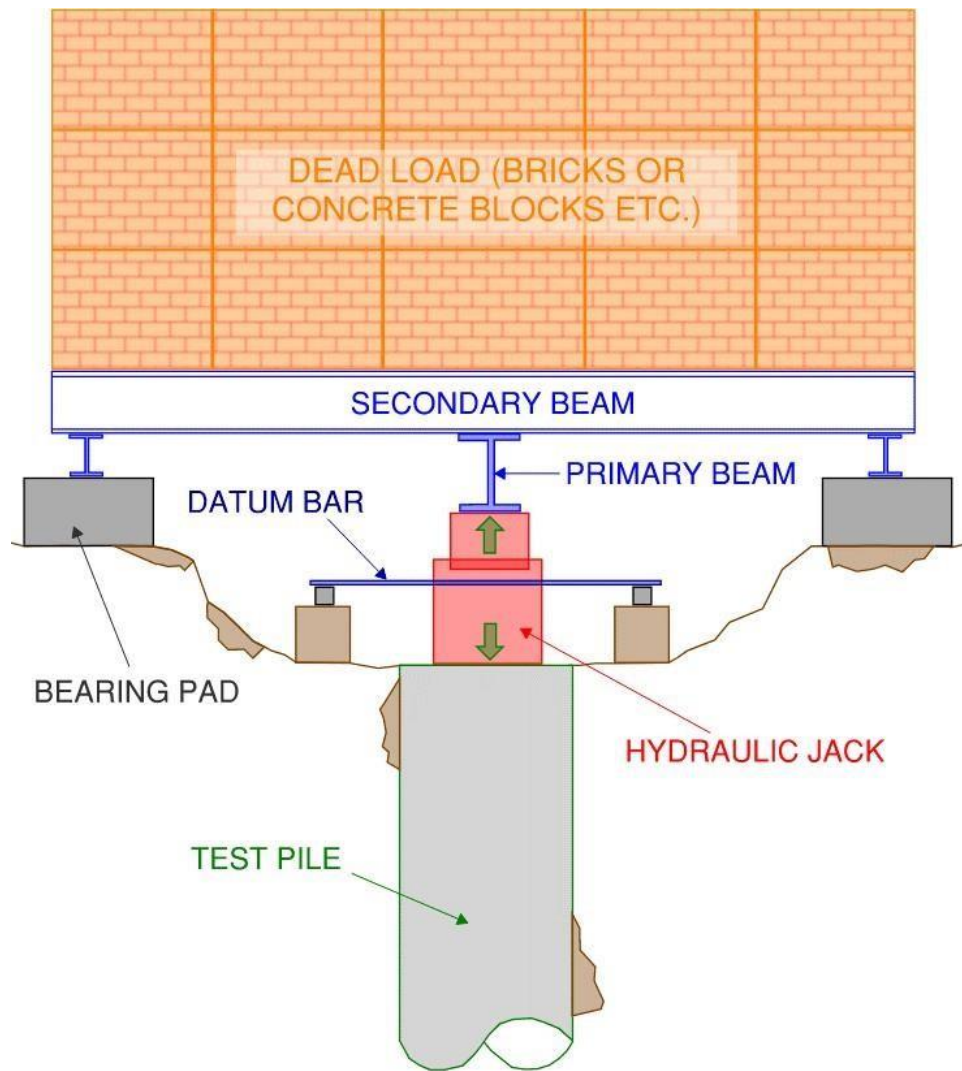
Coupe schématique transversale pour l'essai de charge statique de pieux..
